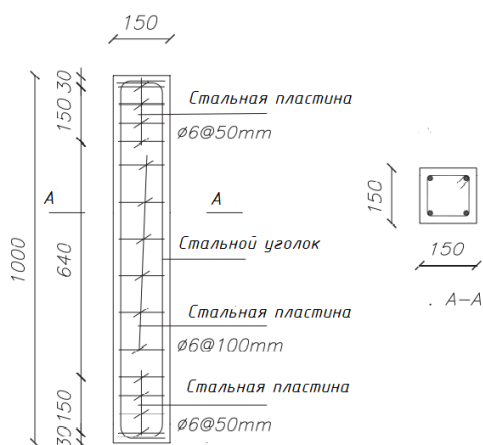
Сплошная стальная обойма усиленной железобетонной колонны
